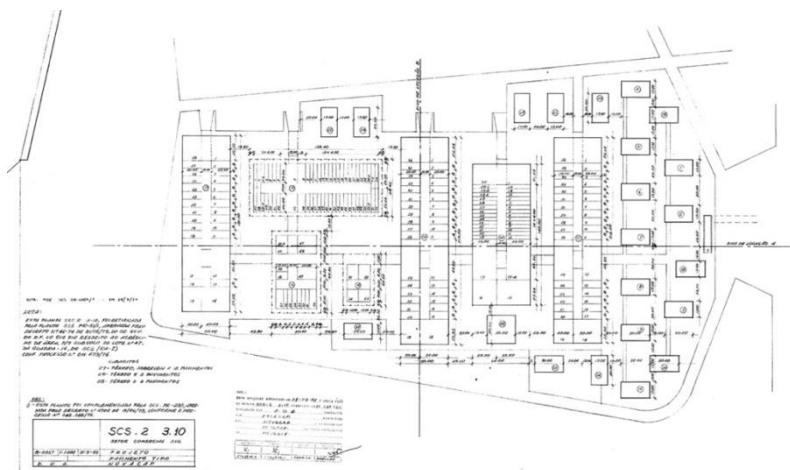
Projeto urbanístico do SCS - Planta de Pavimento-tipo
